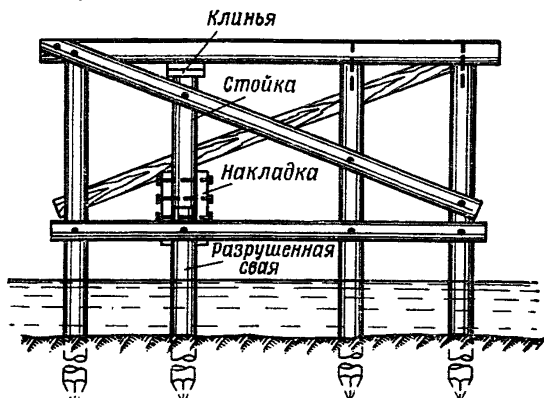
Восстановление разрушенной сваи наращиванием свай стойкой
